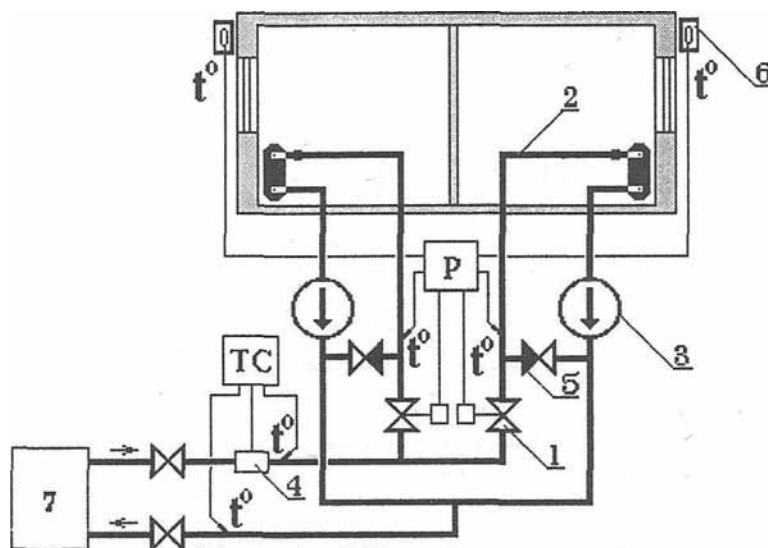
Схема ІТП будівлі з пофасадного регулювання системи опалення, обладнаного циркуляційним насосом
